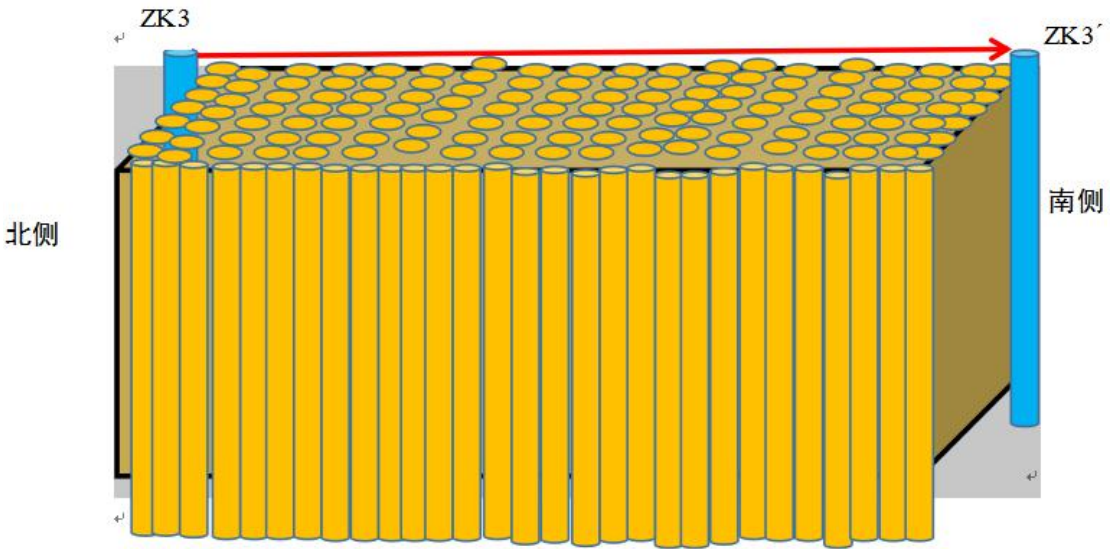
桥基木桩声波CT扫描检测断面布置示意图
